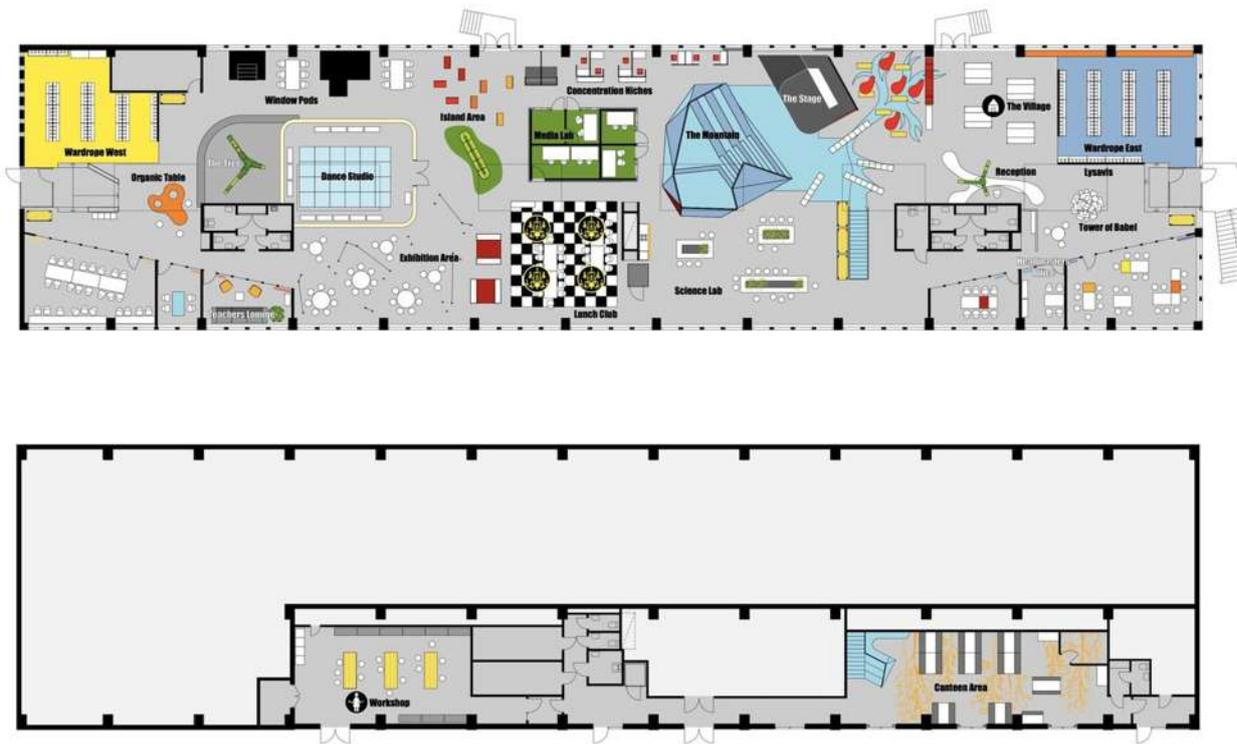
Plantas arquitectónicas . Fuente: Archdaily.
